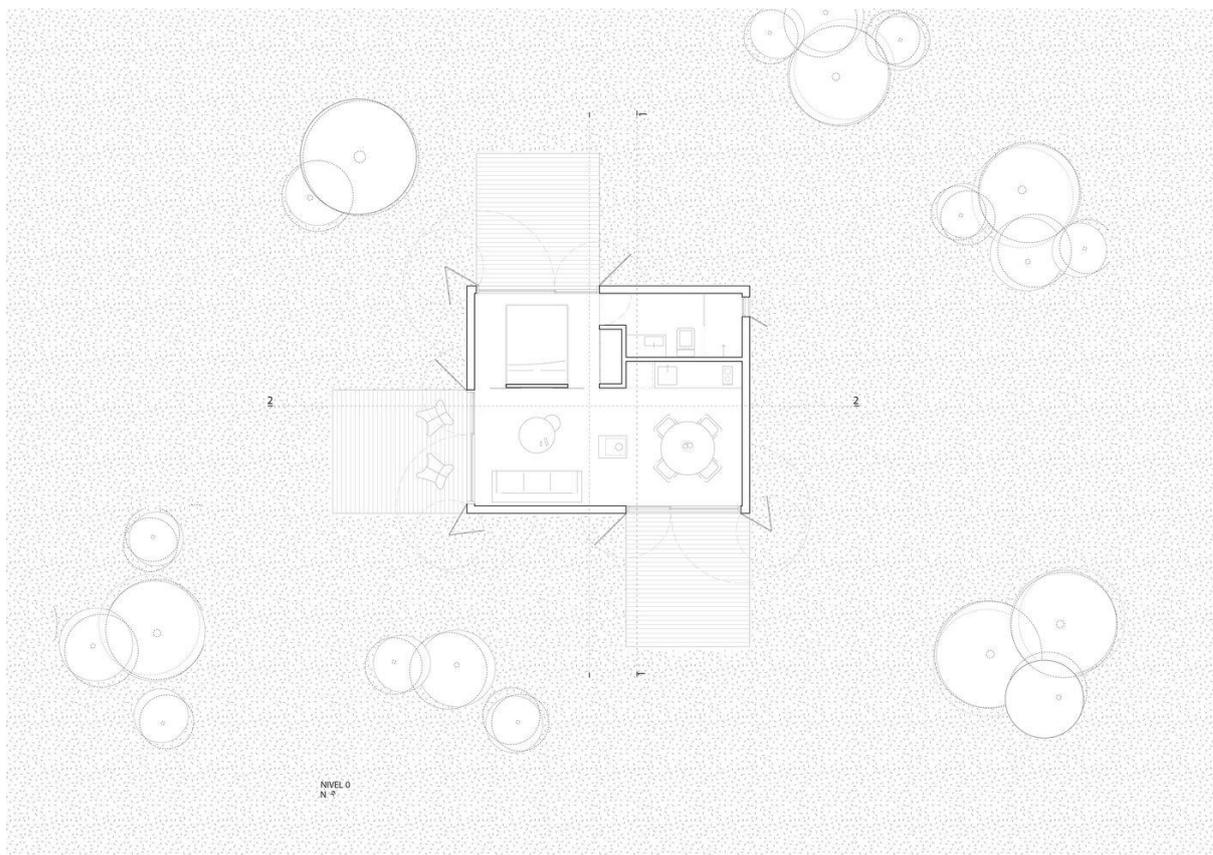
Projeto Casas – Planta. Fonte: (Galeria de Arquitetura).
